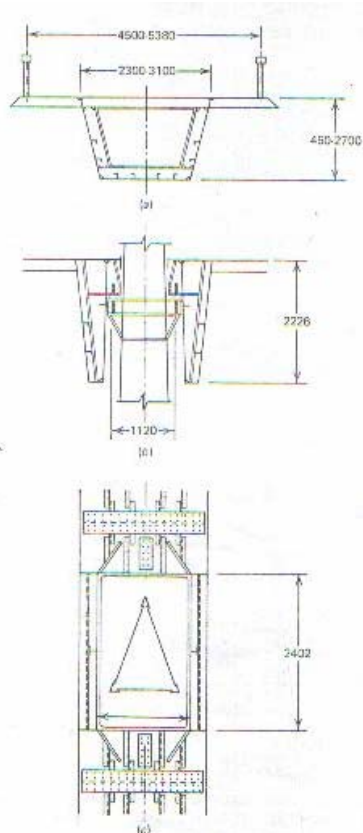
Puente glacischaussee: a) Sección de cruce de la viga; b) Sección de cruce del poste en la viga; c) Planta de la sección de cruce del poste
